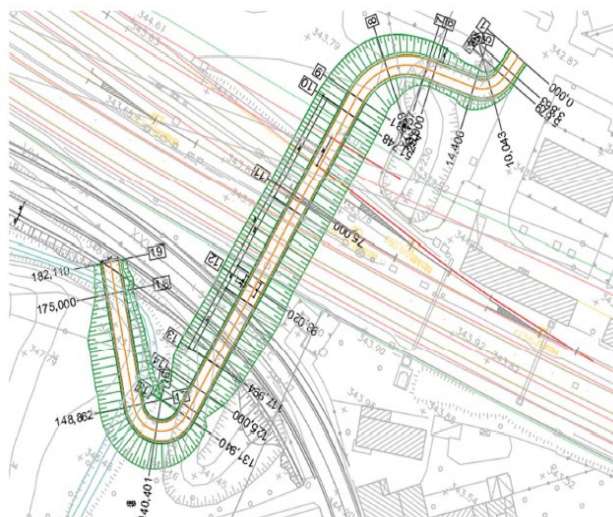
| Sottopasso ciclopeditonale Via IV Novembre (SL07): vista in pianta
